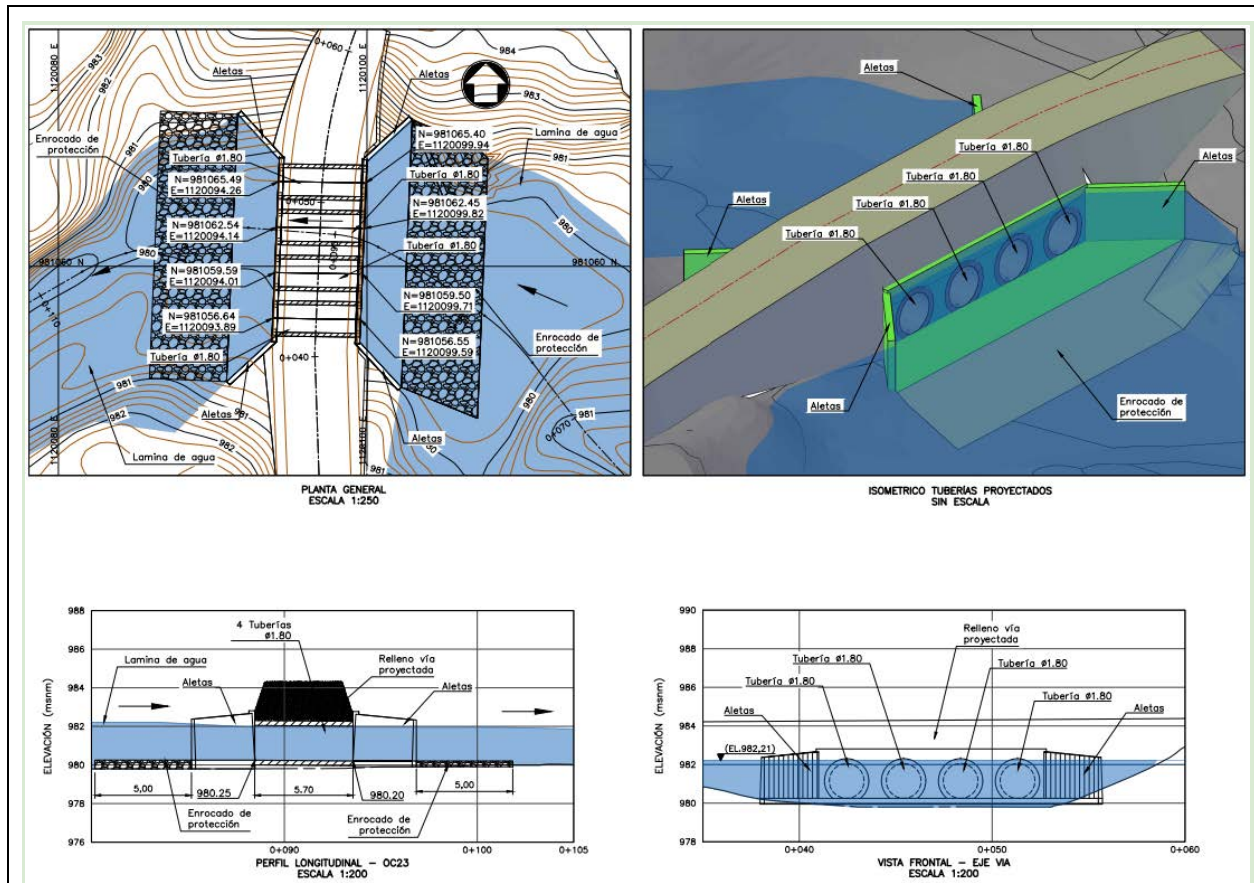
Implantación típica en planta - perfil y cortes para la obra OC23 con tubería de 1,8 m de diámetro y cuatro celdas.
